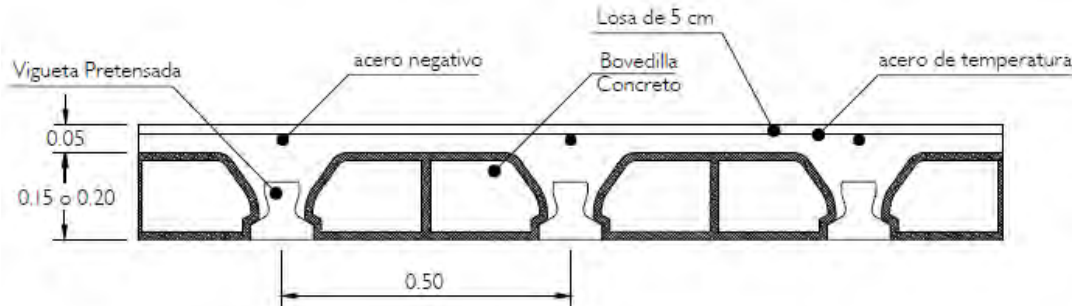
Sección transversal de losa con viguetas prefabricadas (CONCREMAX, s.f.)
